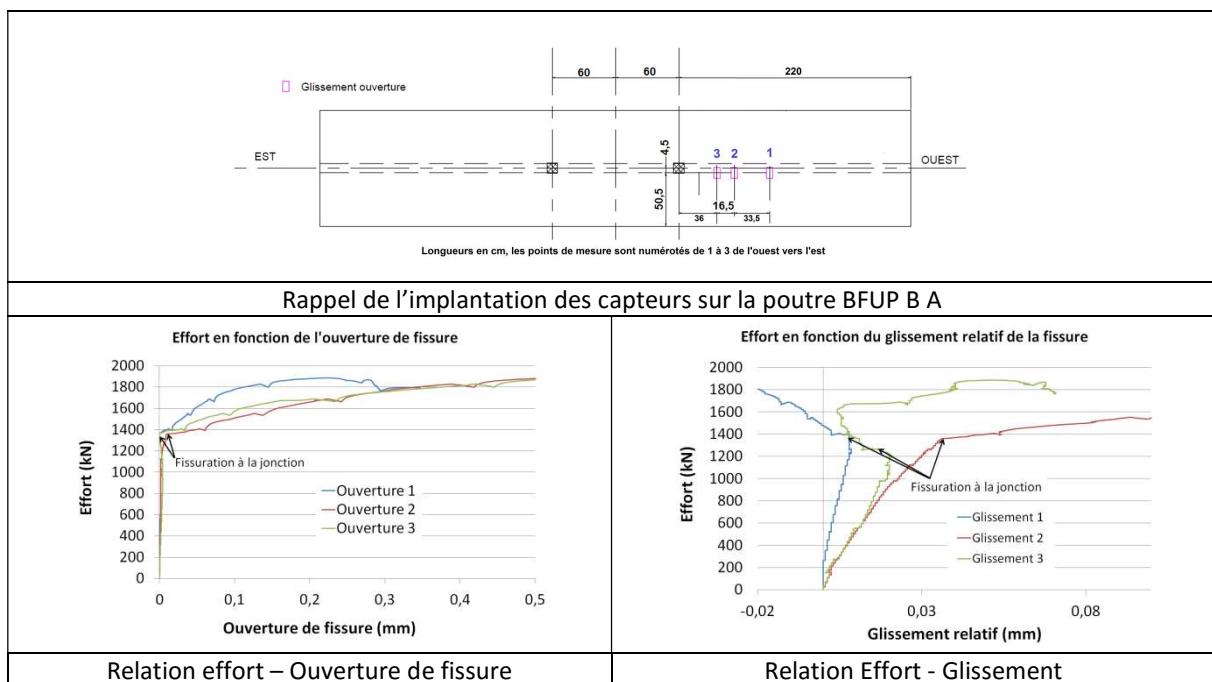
Evolution de la fissuration de ruine poutre BFUP B A
